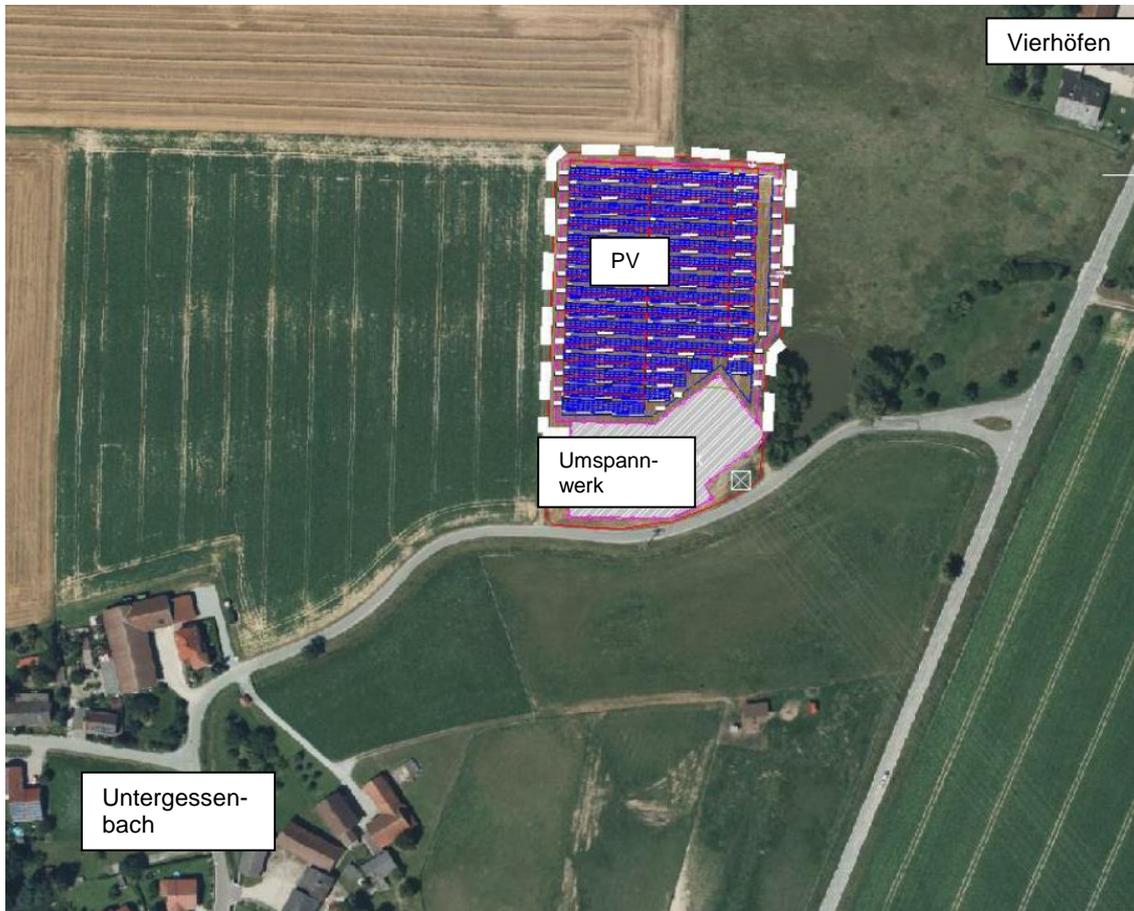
Lageplan Standortsituation mit PV-Anlage und Umspannwerk (unmaßstäblich, Quelle: SOLEA GmbH)
